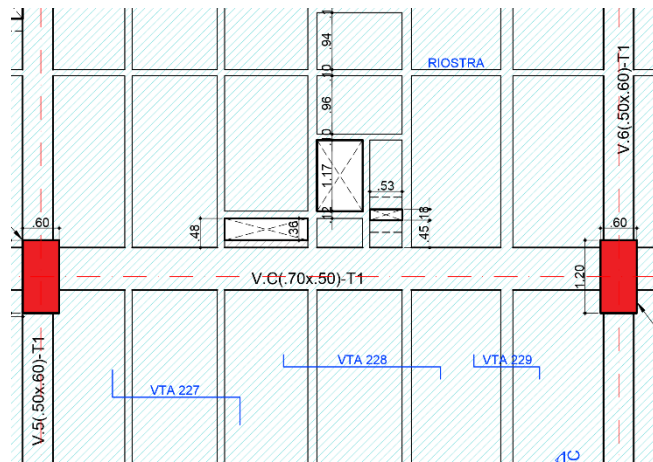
Zoom Planta estructural PISO 15-22 (MARVAL, 2019)
